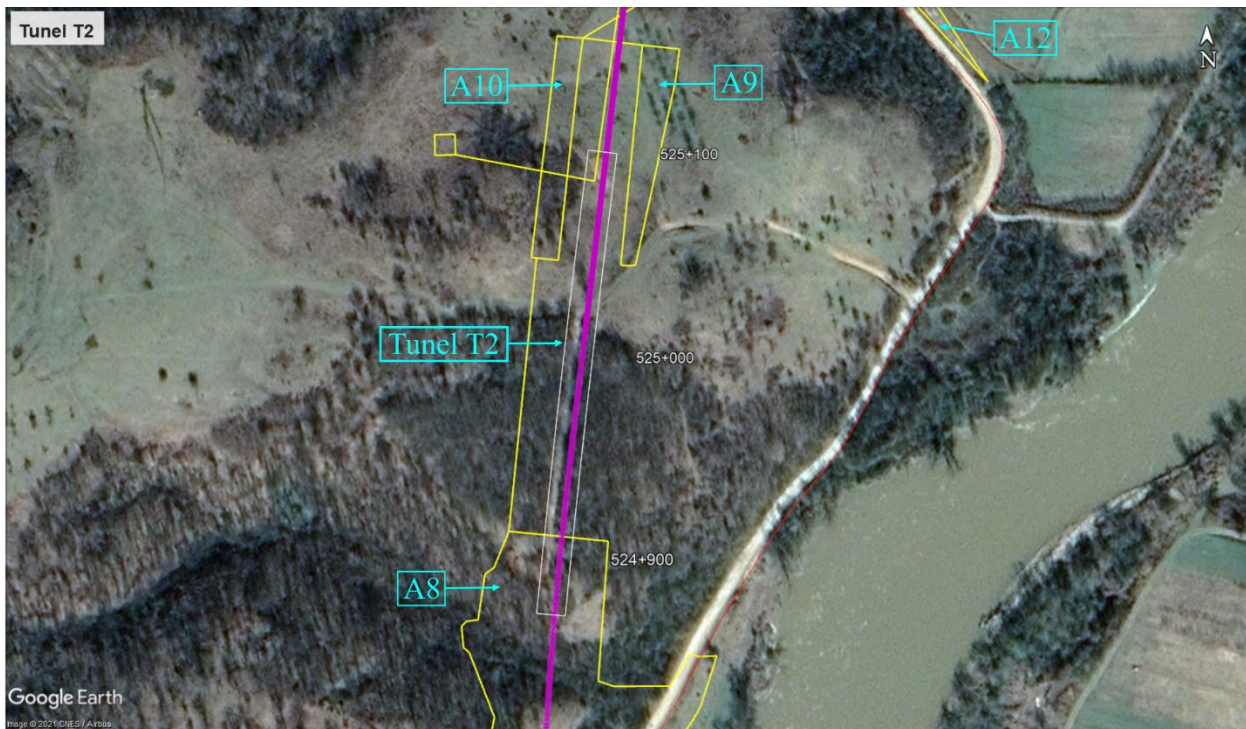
Plan de amplasament al Tunelului T2, jud. Hunedoara – vedere din satelit
